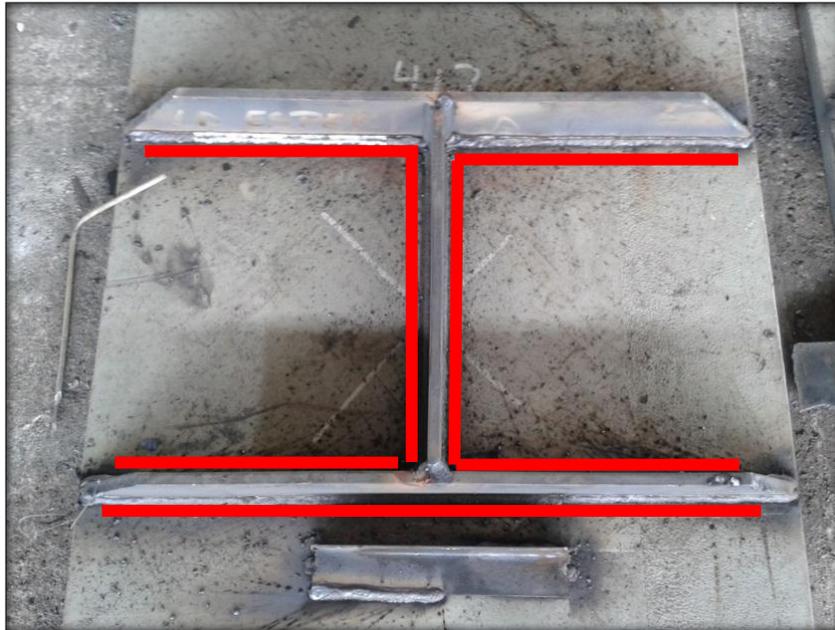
Refuerzo Interno en Unión Viga-Columna con soldadura continua a ambos lados
